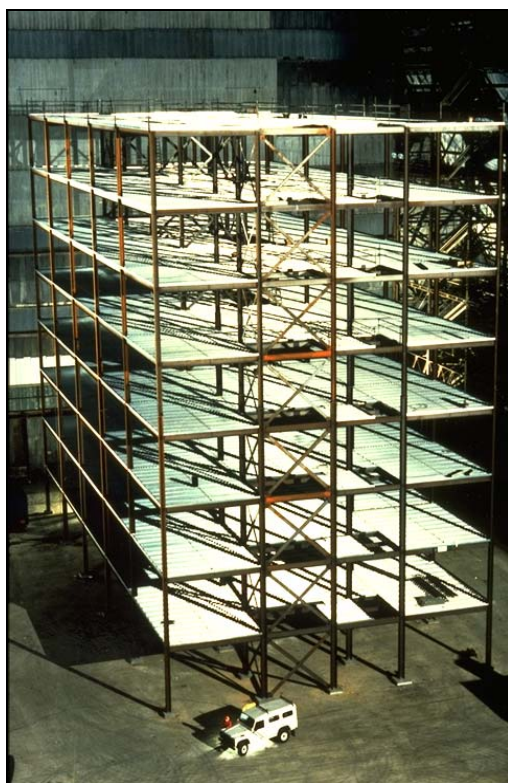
Structure de l'essai de Cardington avant de couler les dalles de béton des planchers
